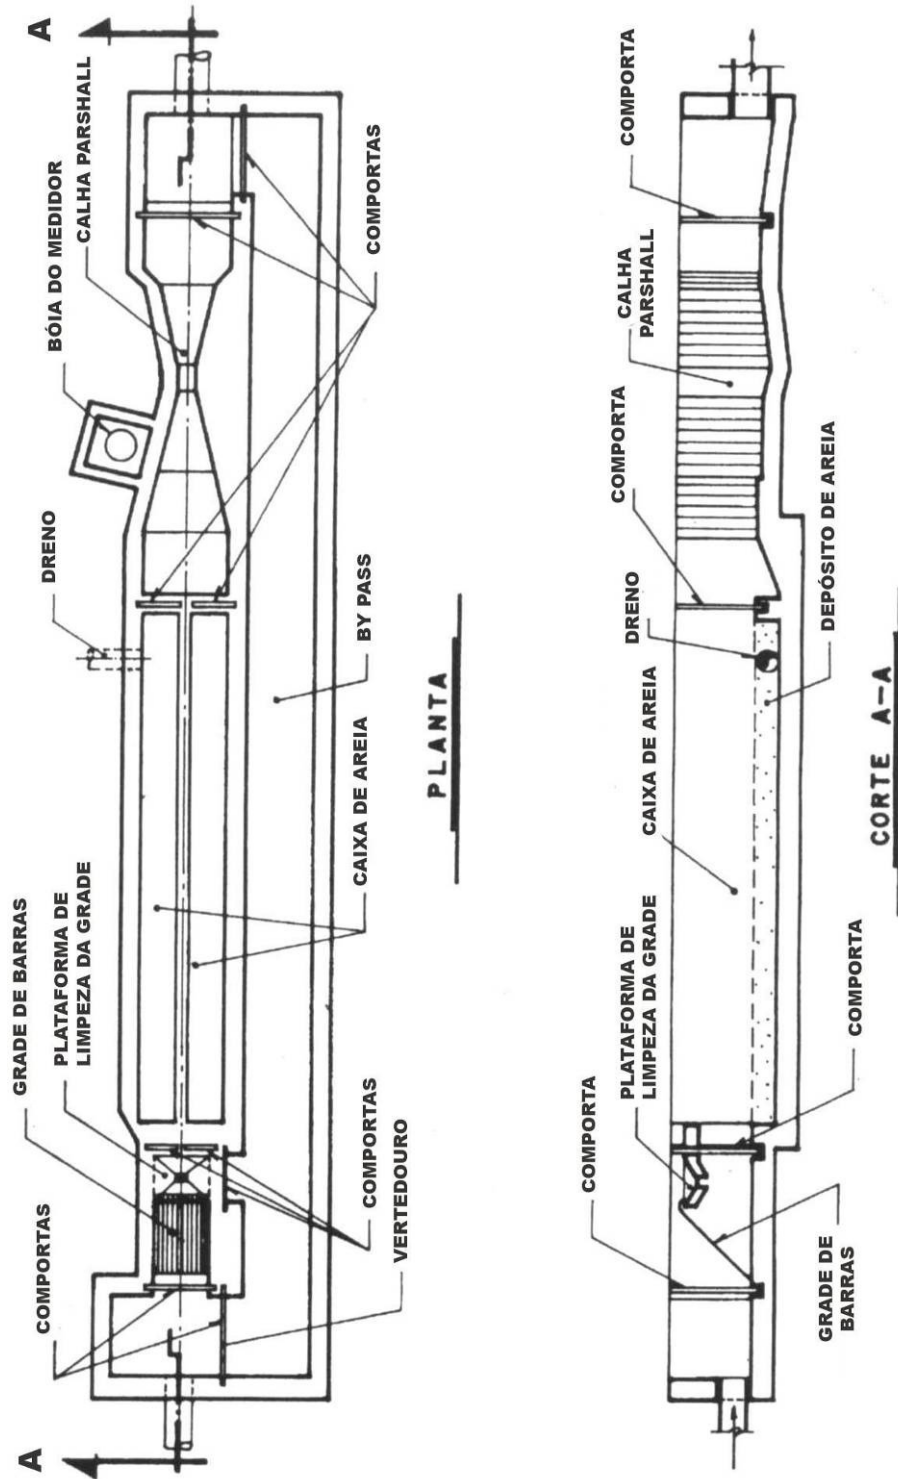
Desarenador prismático retangular de câmaras paralelas
